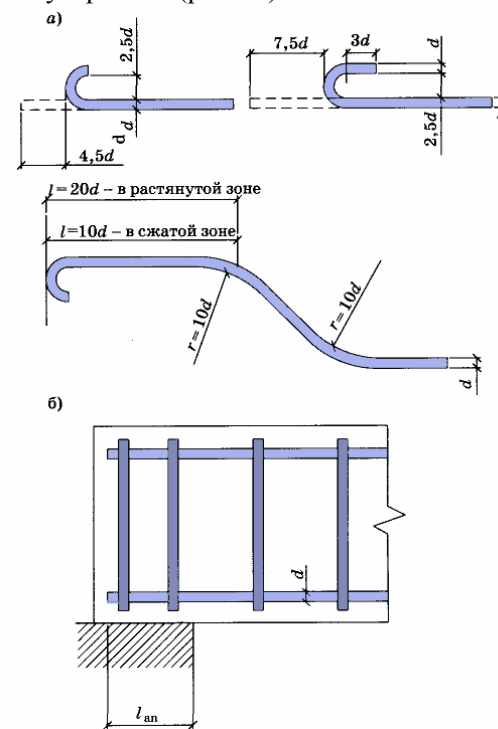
Анкеровка арматуры: а – круглых гладких стержней; б – стержней периодического профиля на свободной опоре балки
